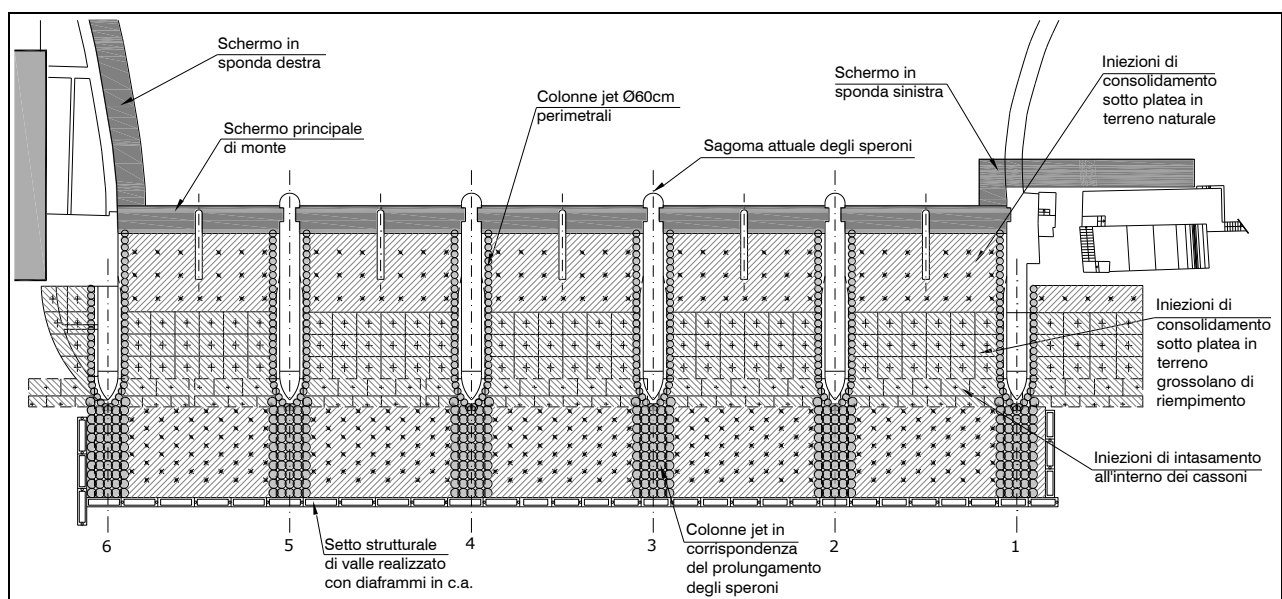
Planimetria degli interventi di consolidamento del terreno in corrispondenza della traversa principale.
